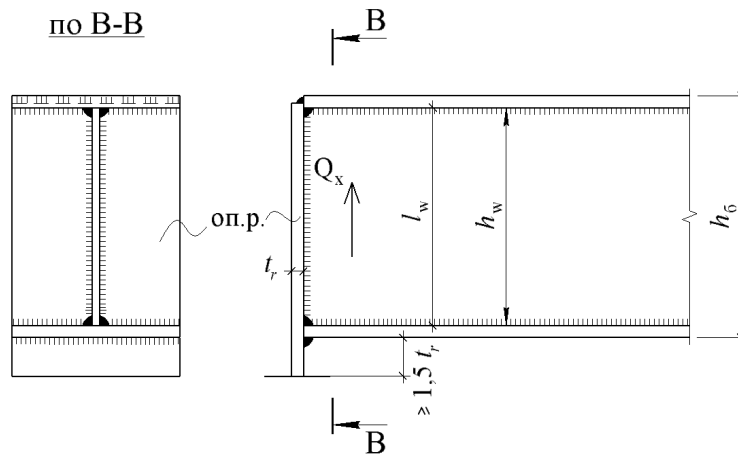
Схема сварного соединения на угловых швах торцевого опорного ребра в балке: $l_w = h_w$
